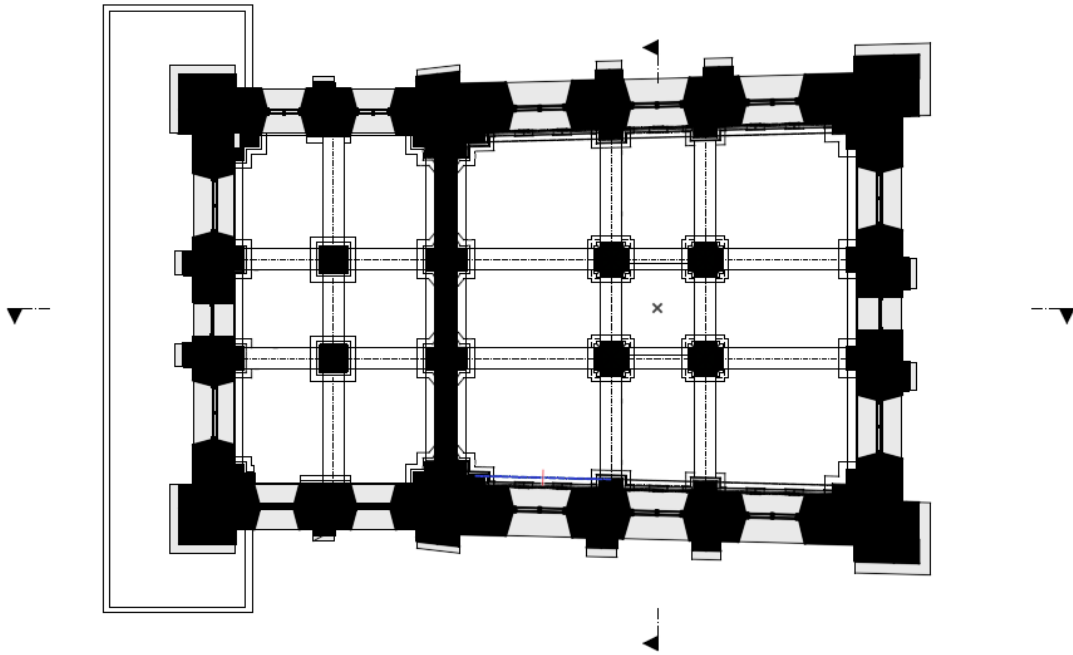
Grundriss_OG_Rekonstruktion
